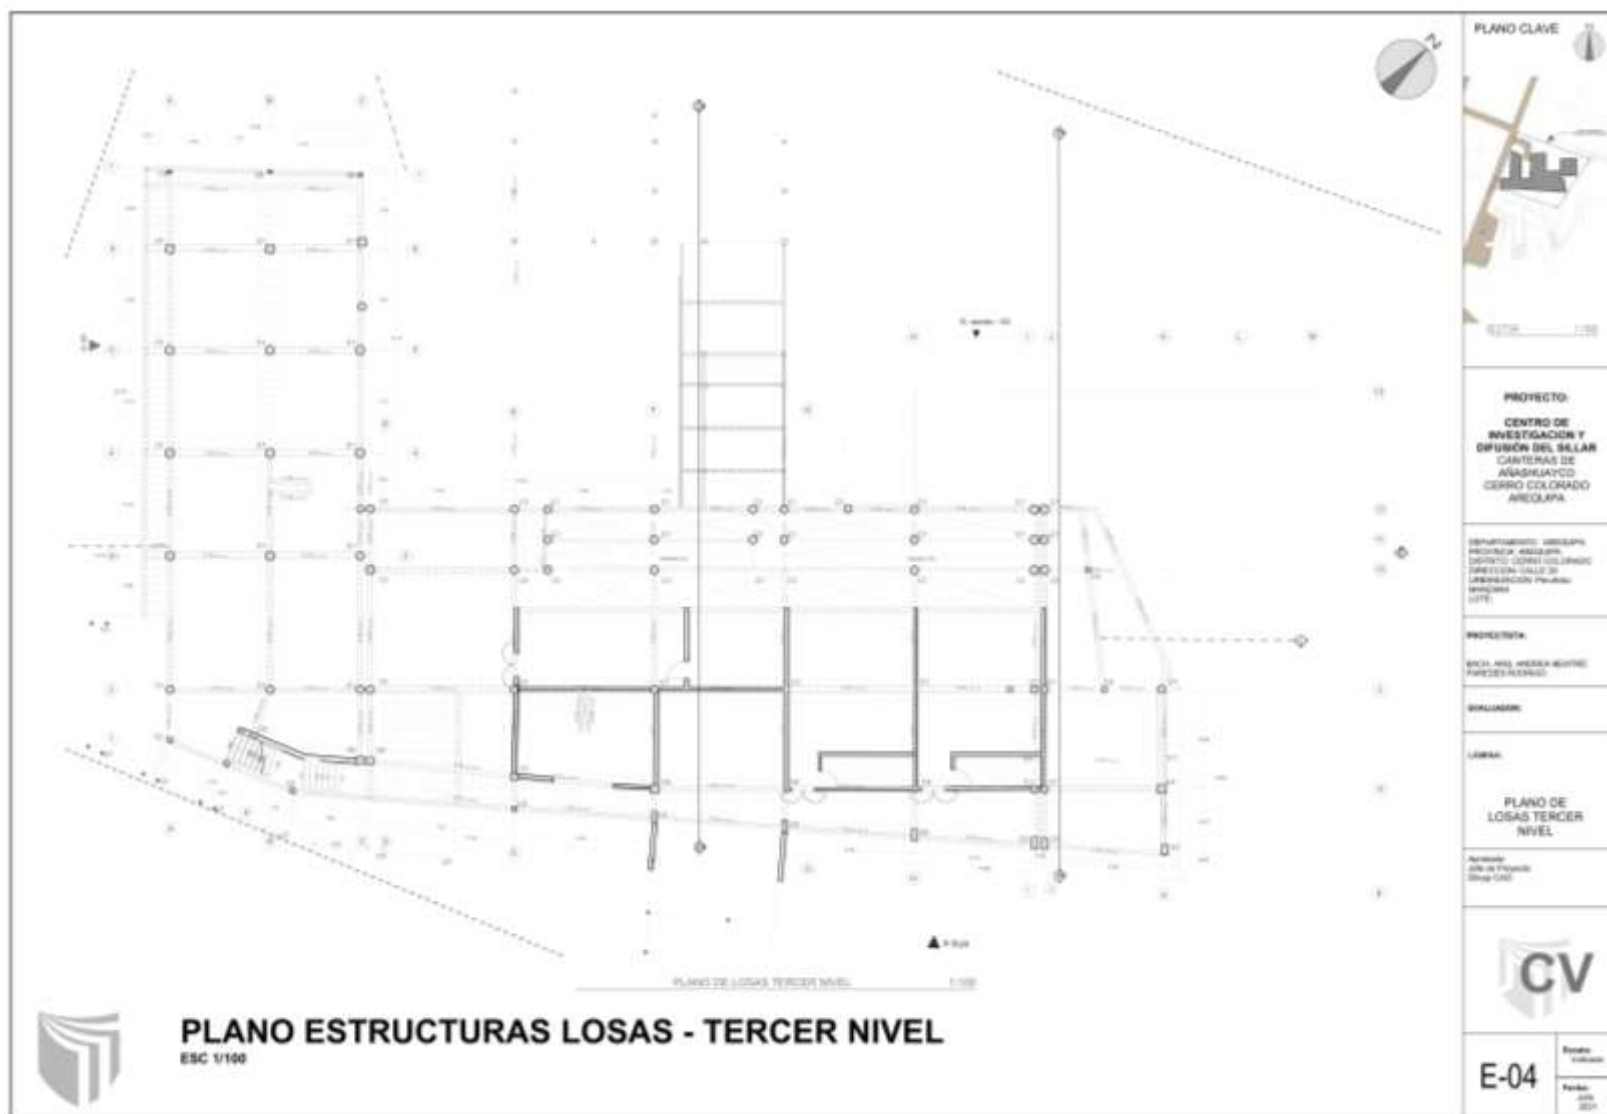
Plano de Estructura de Losa y techos – Sector –Área Académica E-04.
